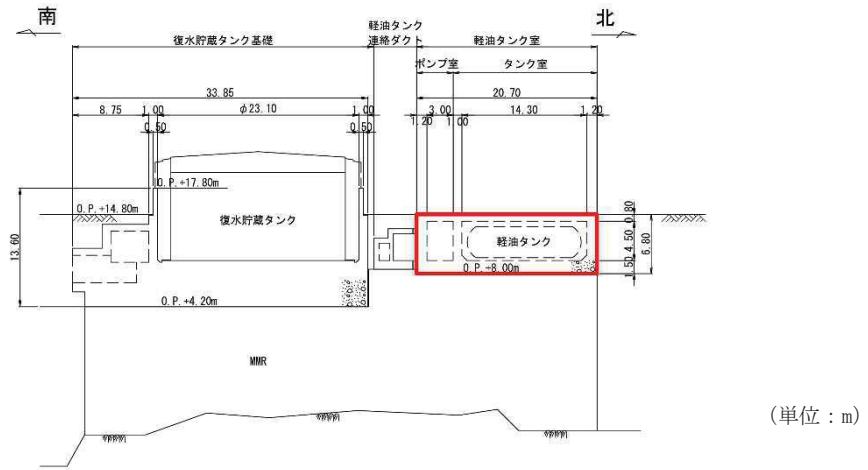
軽油タンク室断面図 (A-A 断面, 南北)
